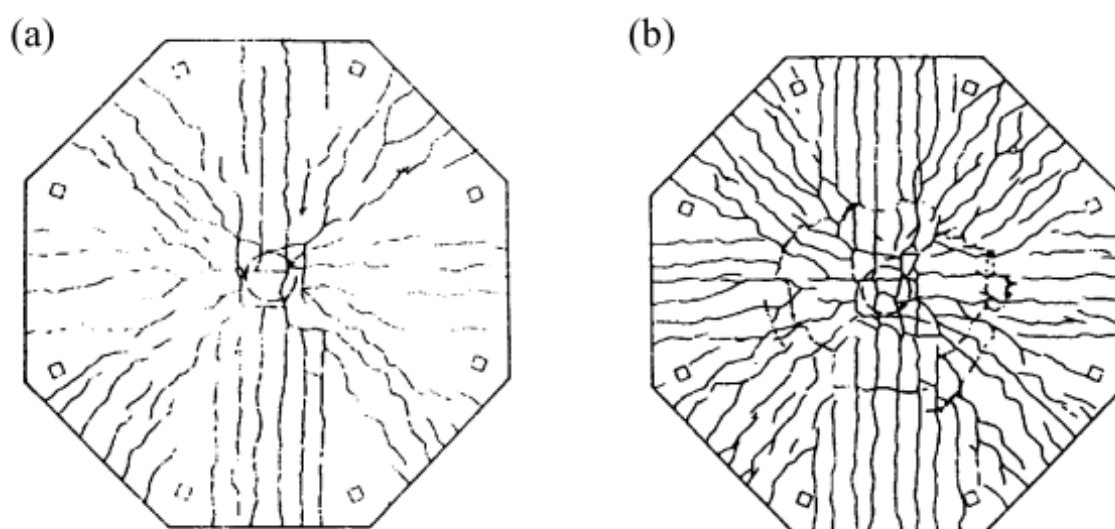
Estágios de fissuração na face superior de uma laje simétrica (Lima, 2001, p.6)
